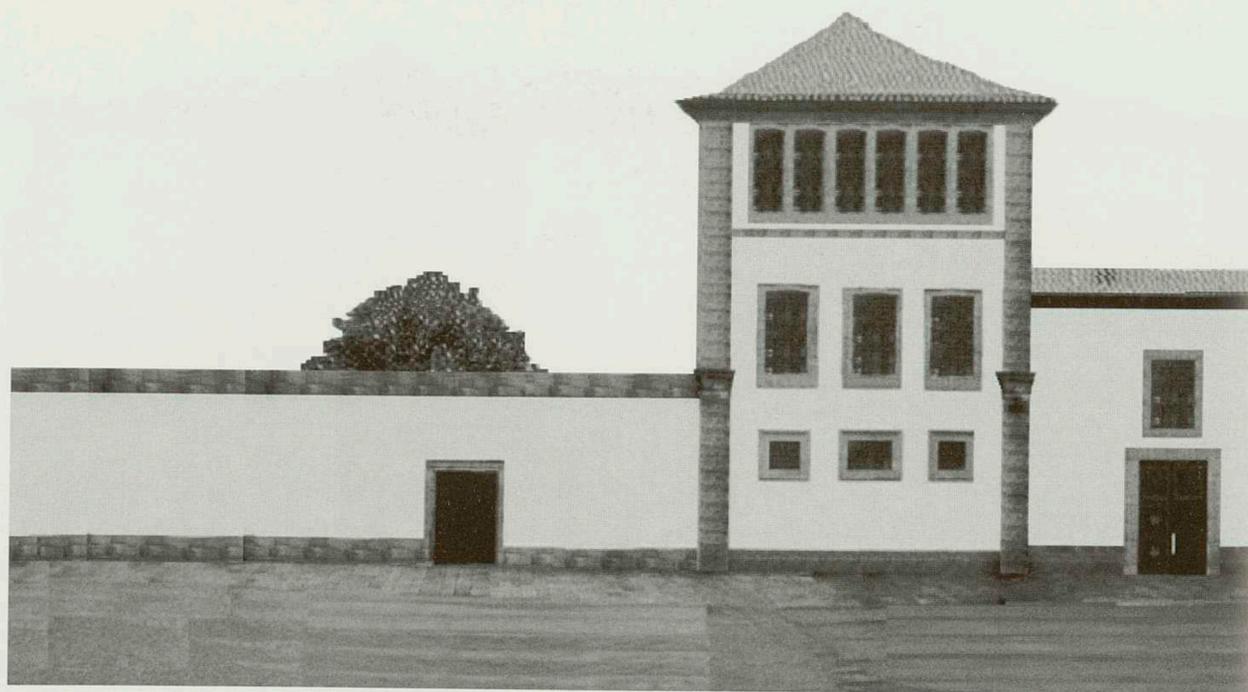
Foto-montagem. Hipótese da fachada do convento de St^a. Clara aquando da construção inicial. Do lado esquerdo, o muro envolvente da clausura. À direita, o mirante e entrada da igreja.
